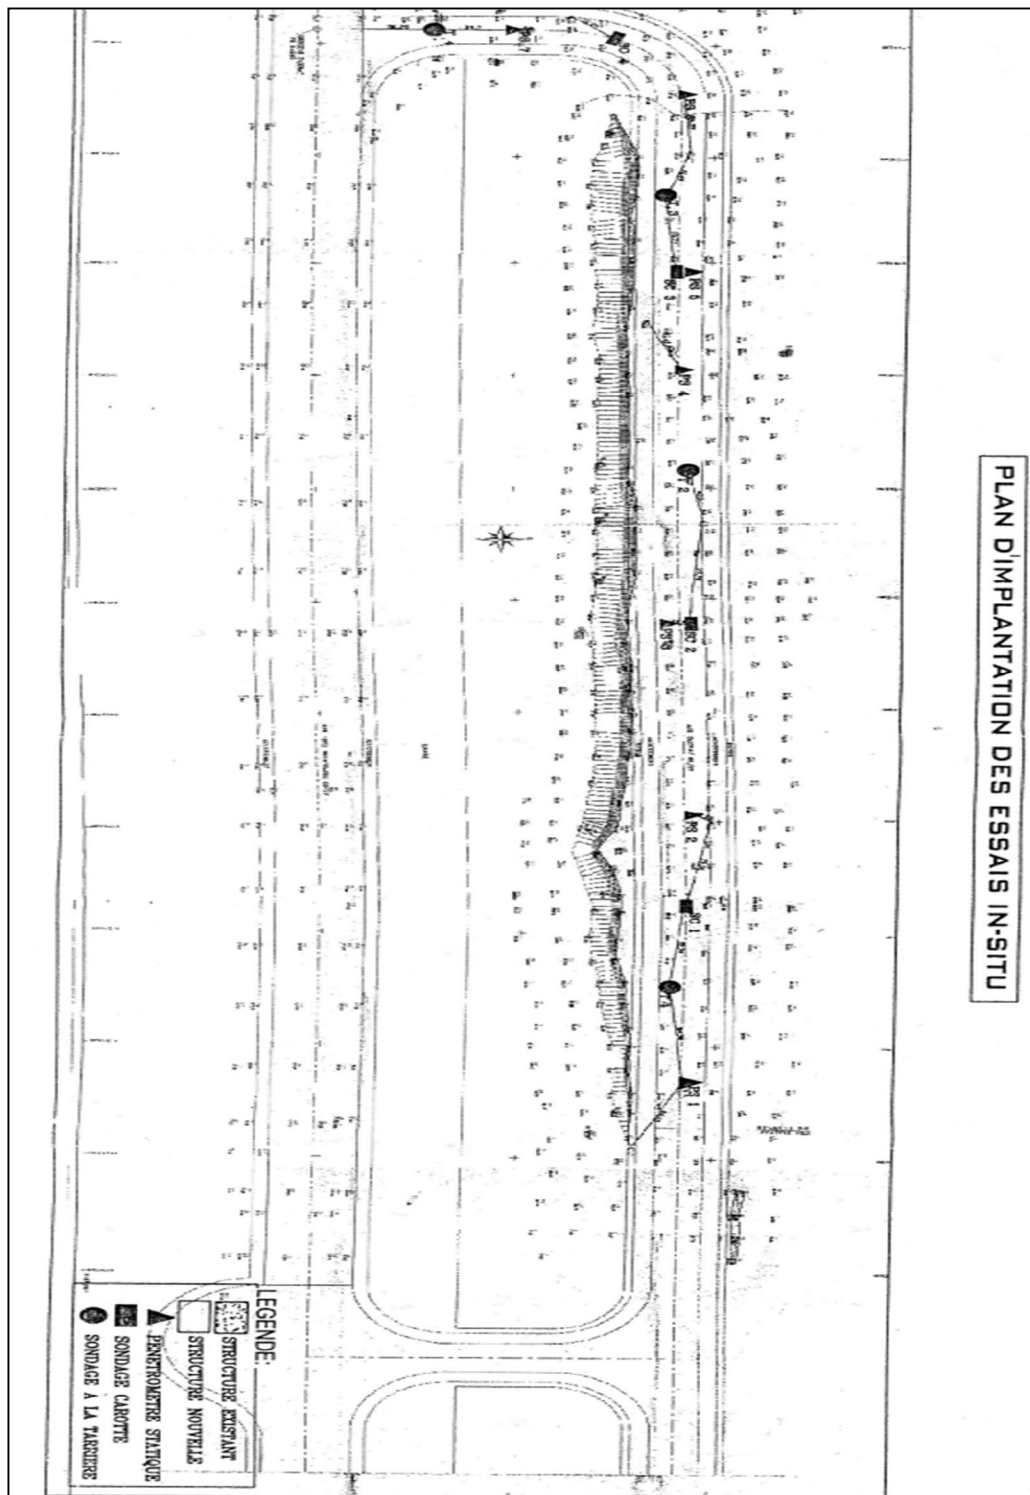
Plan d'implantation des essais in-situ sur le taxiway de la piste secondaire [Rapport géotechnique LCTP]
